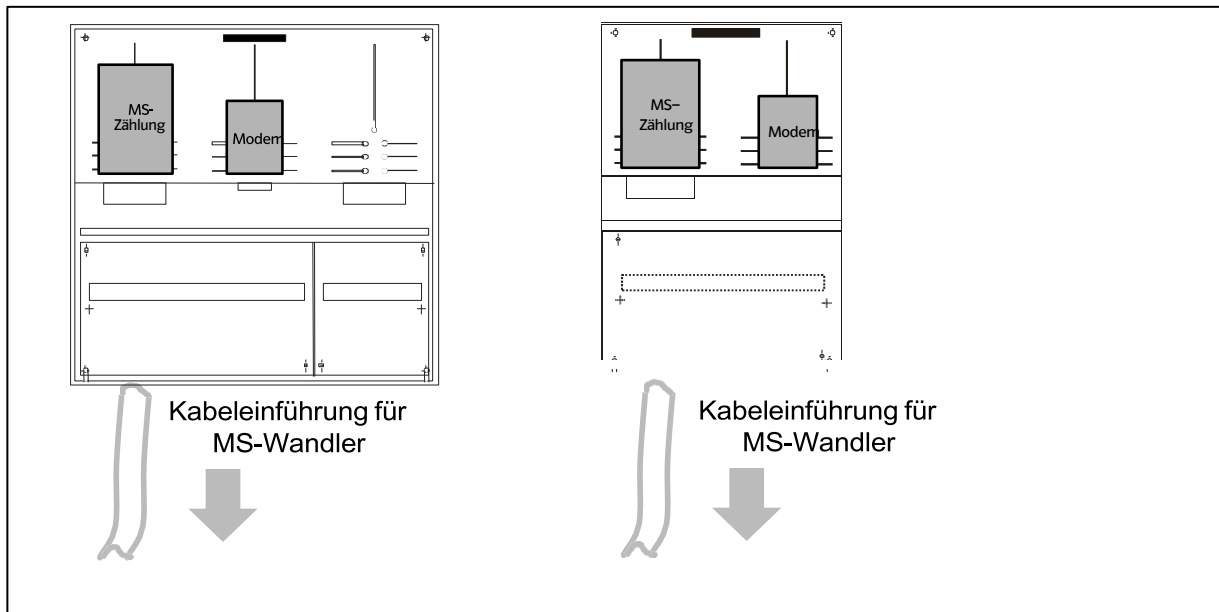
MS-Messung mit einem Zählpunkt, Zählerschrank 800x800x225 mm oder 800x550x225 mm
